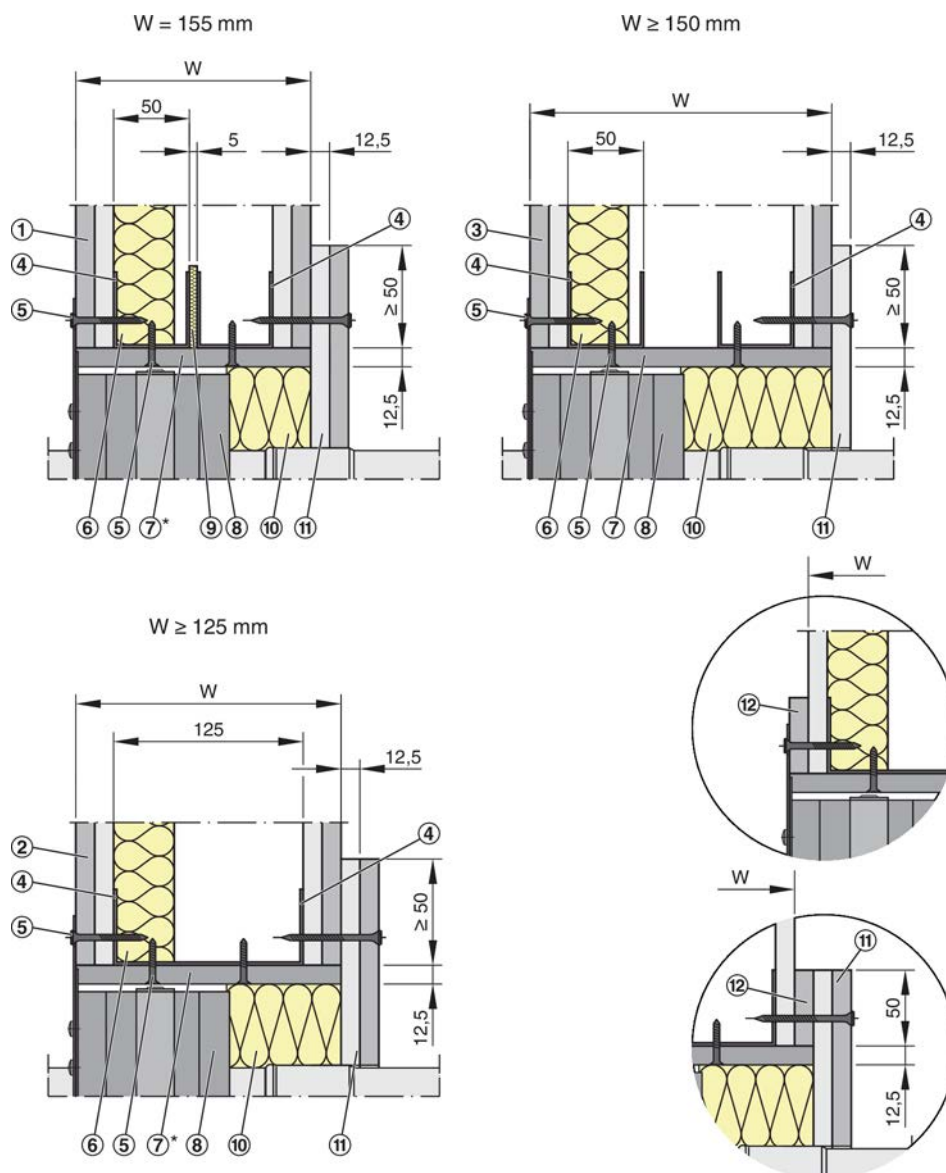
Trockeneinbau in Leichtbauwände mit  $W \geq 125$  mm
